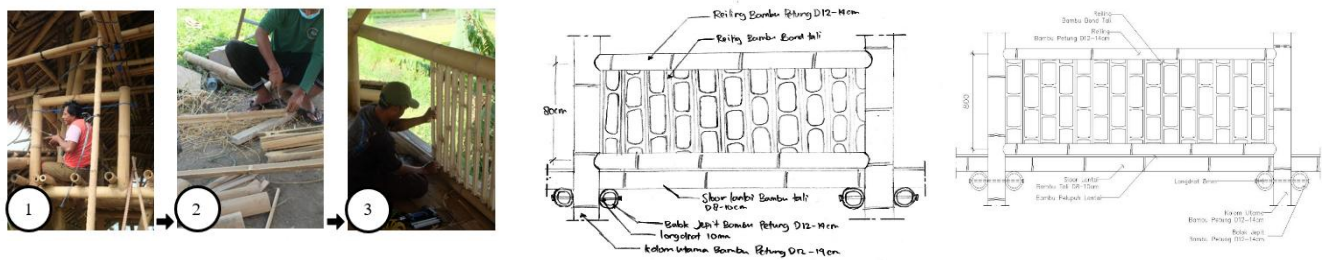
Dokumentasi, Sketsa dan Gambar Autocad Detail Pemasangan Balok Jepit Pada Lantai 2 (Analisis Penulis, 2021)
